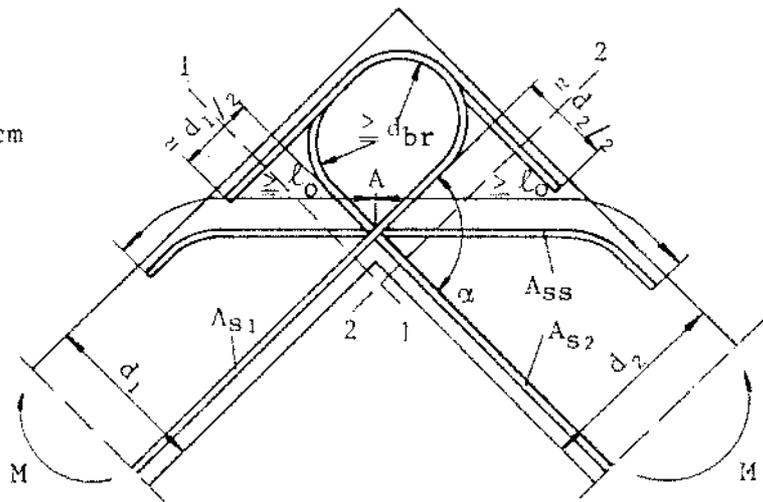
Ejemplo de conformación de una esquina de pórtico solicitada por un momento positivo y con una disposición de la armadura en forma de bucle.
